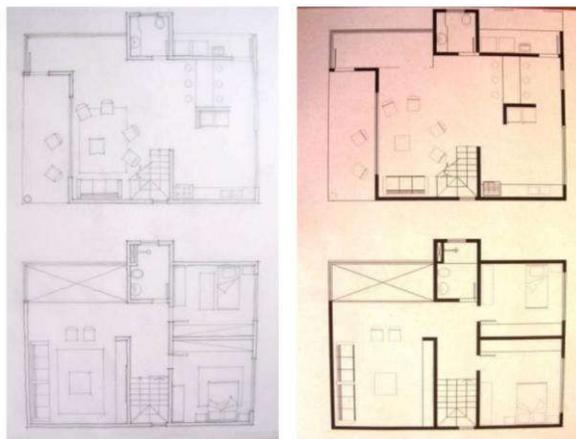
Exemplo de planta desenhada "a mão" e em CAD
